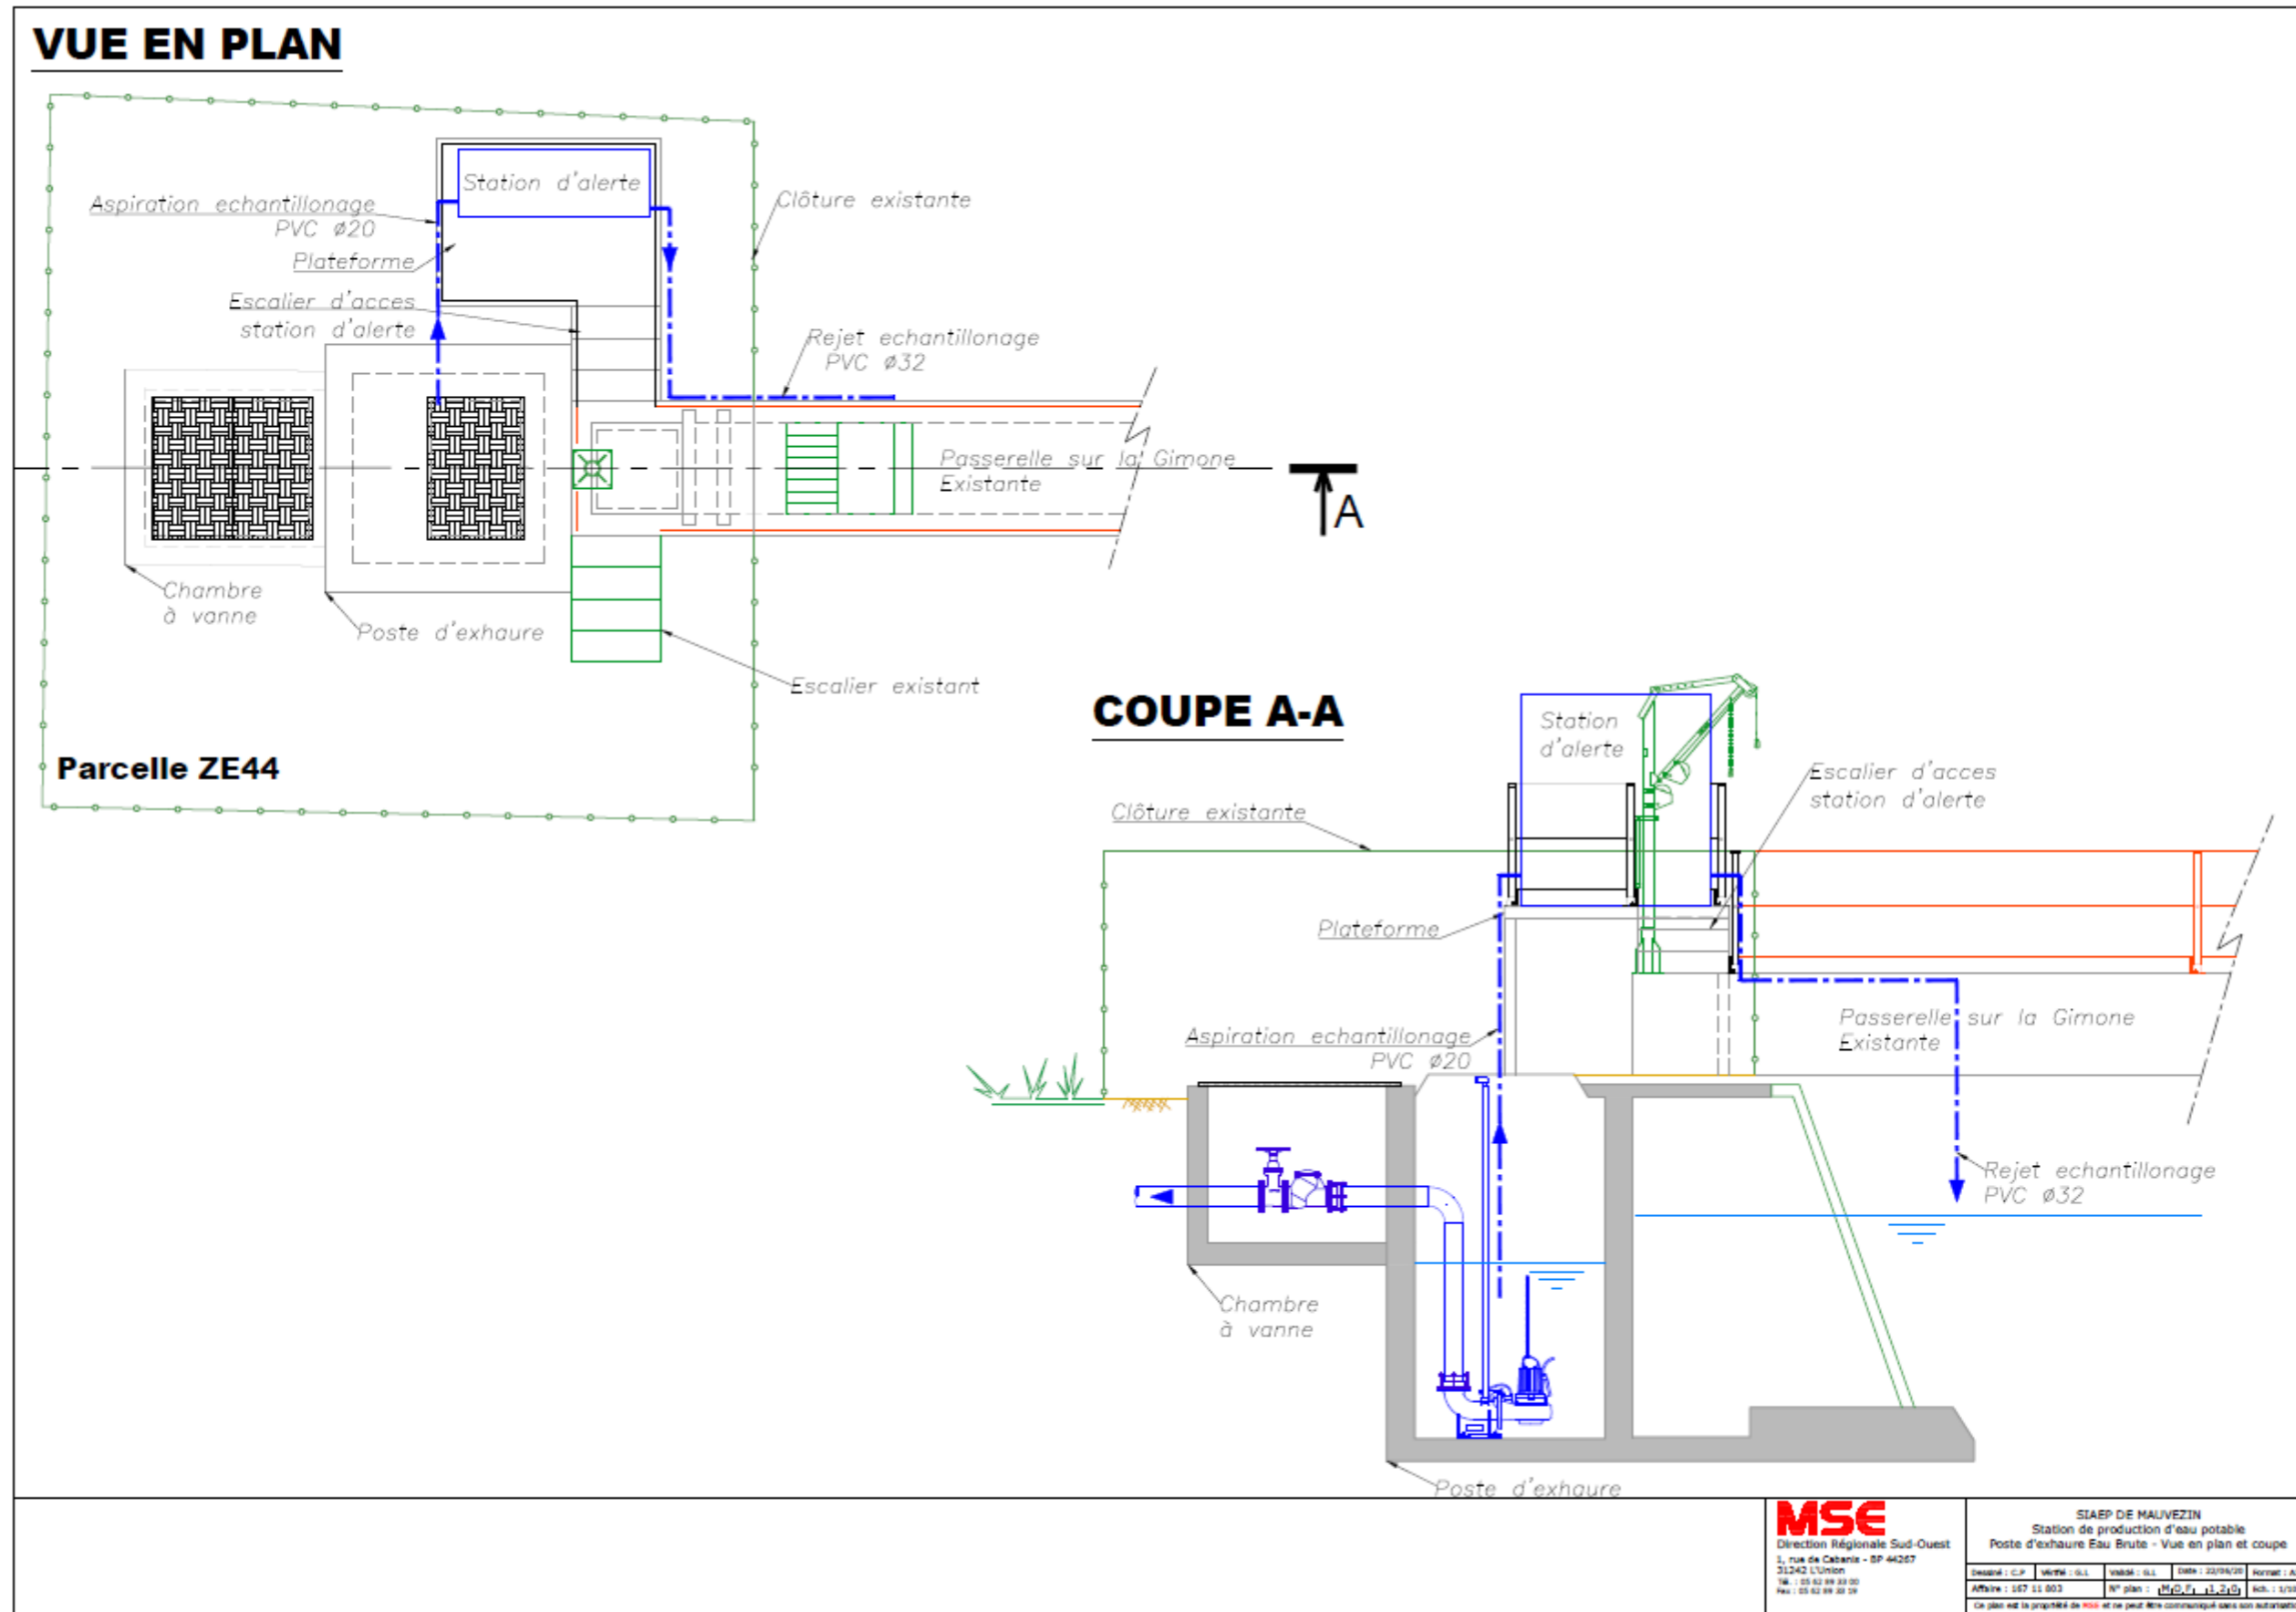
Poste d'exhaure eau brute (plan projet) – Vue en plan de coupe (Véolia)
